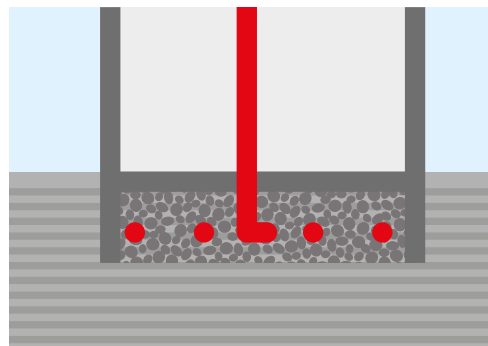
Einbau Radondrainage in dichtes Erdreich (Rohrabstand 1 m bis 3 m).
